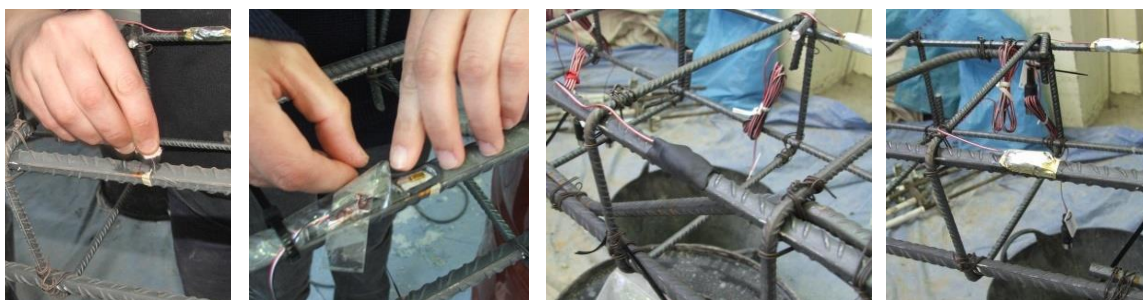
Colocación y protección de las galgas adheridas a las armaduras
